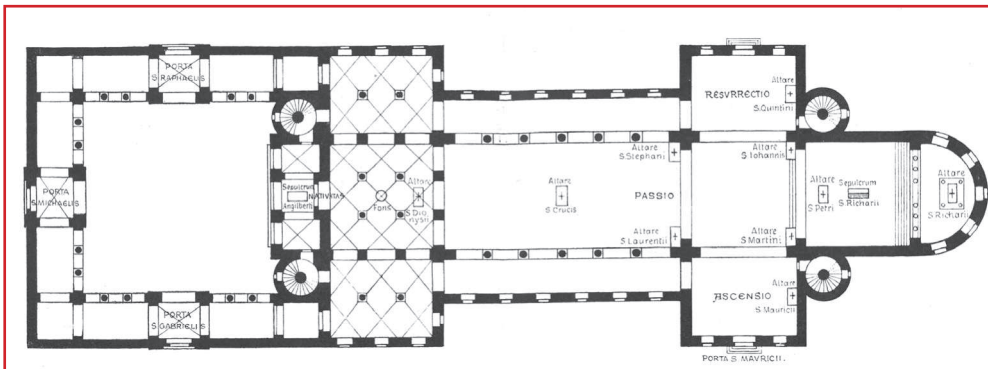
Saint-Riquier, Grundriss (Effmann)
